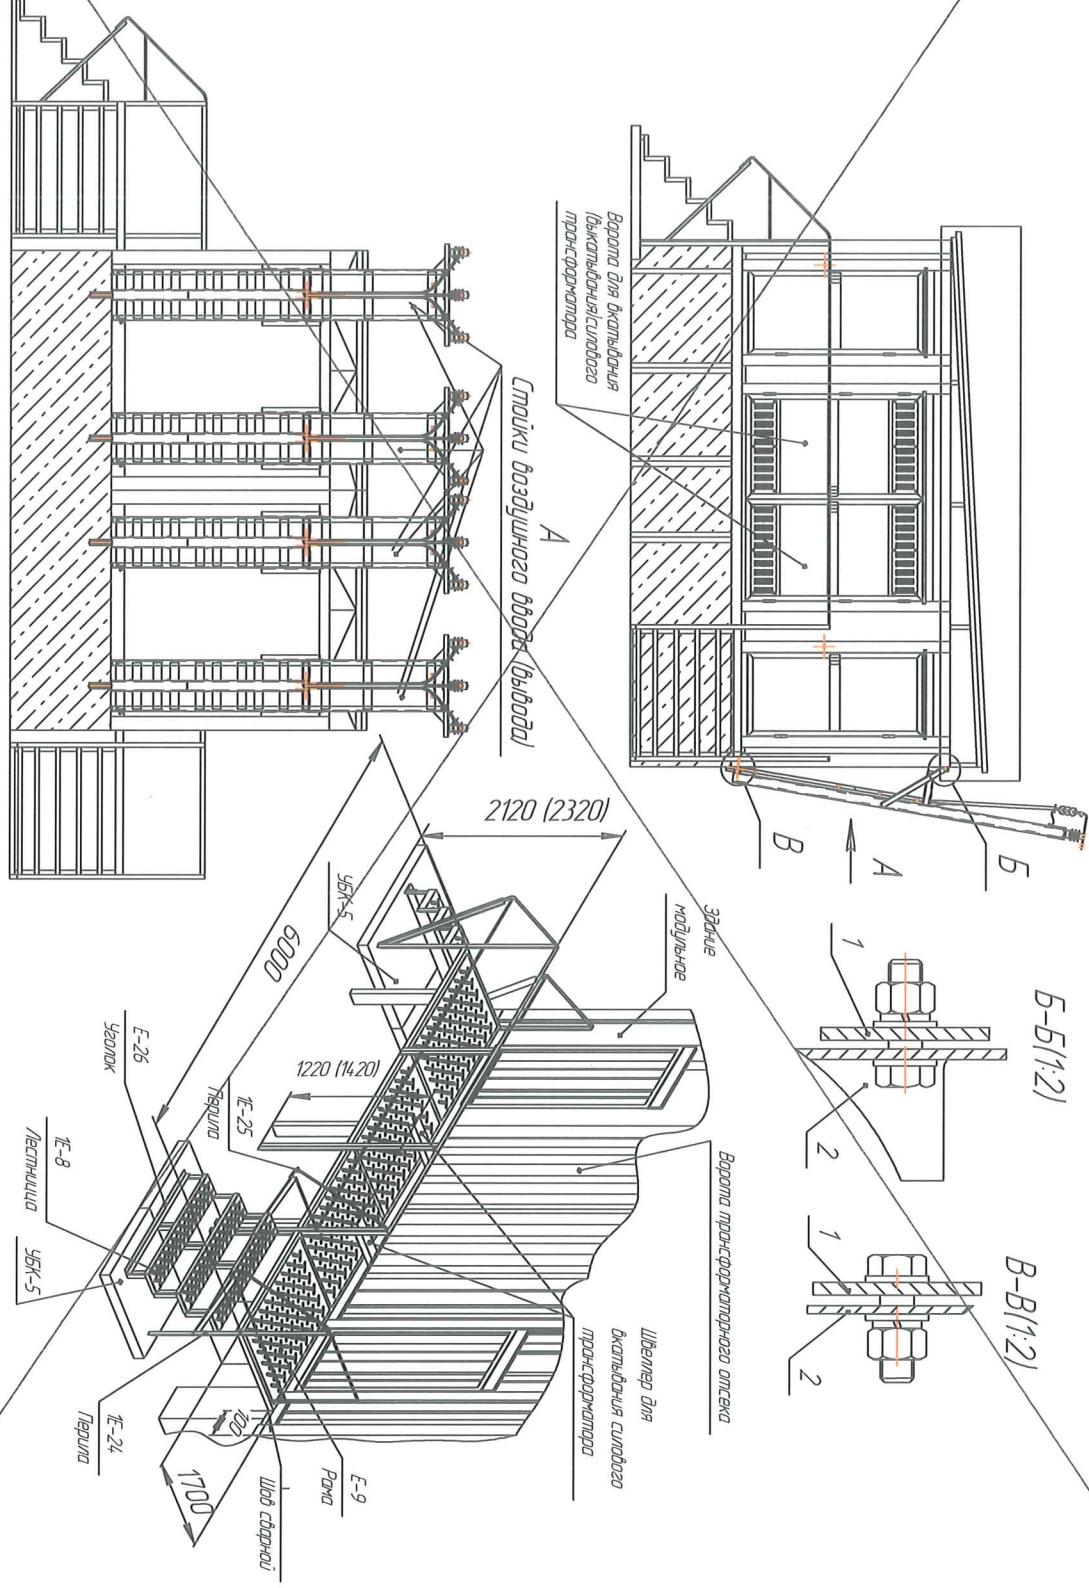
Крепление стойки воздушного щита, установленка плашадок с перилами и лестницей в 2КПТ-СЩ-Г
